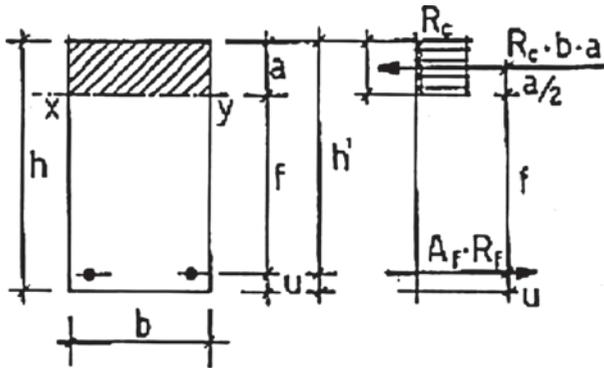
Schema per il calcolo delle travi nel sistema Hennebique
